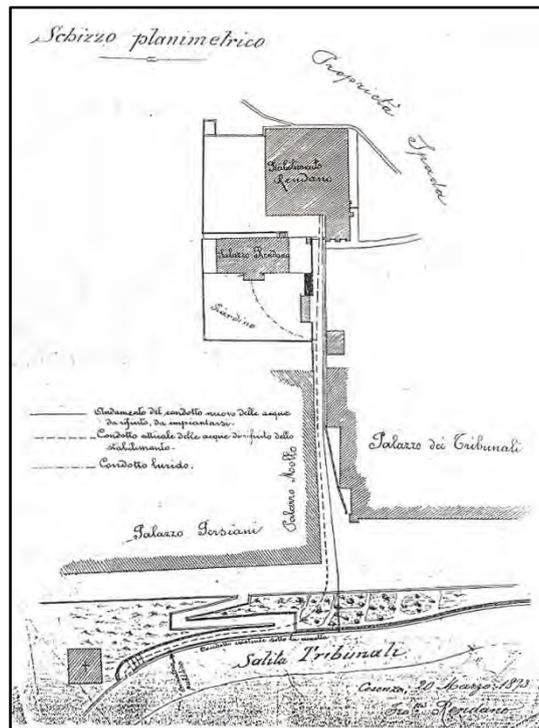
Schizzo planimetrico proprietà dei Fratelli Rendano
